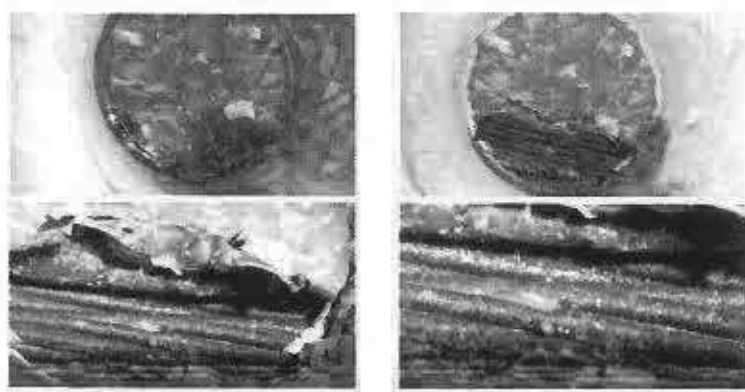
foto estrapolate dalla relazione GEN001A, rappresentanti i cavi secondari della pila n.9 e 10
